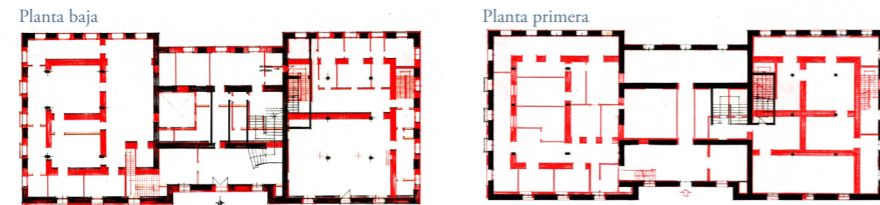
Antes/después de la distribución en planta. Elaboración propia
